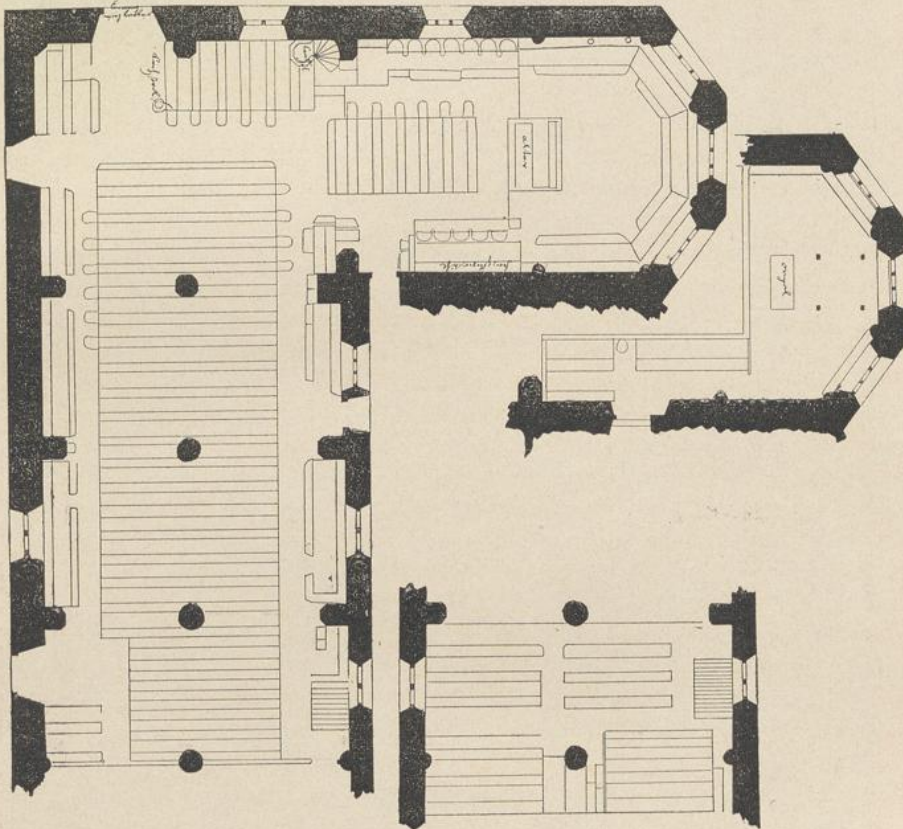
Heiliggeist-Kirche: Grundriss.
